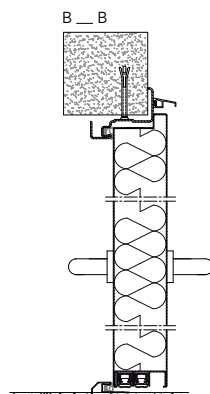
Coupe verticale d'un bloc-porte d'extérieur ECO Tech avec bâti angulaire
